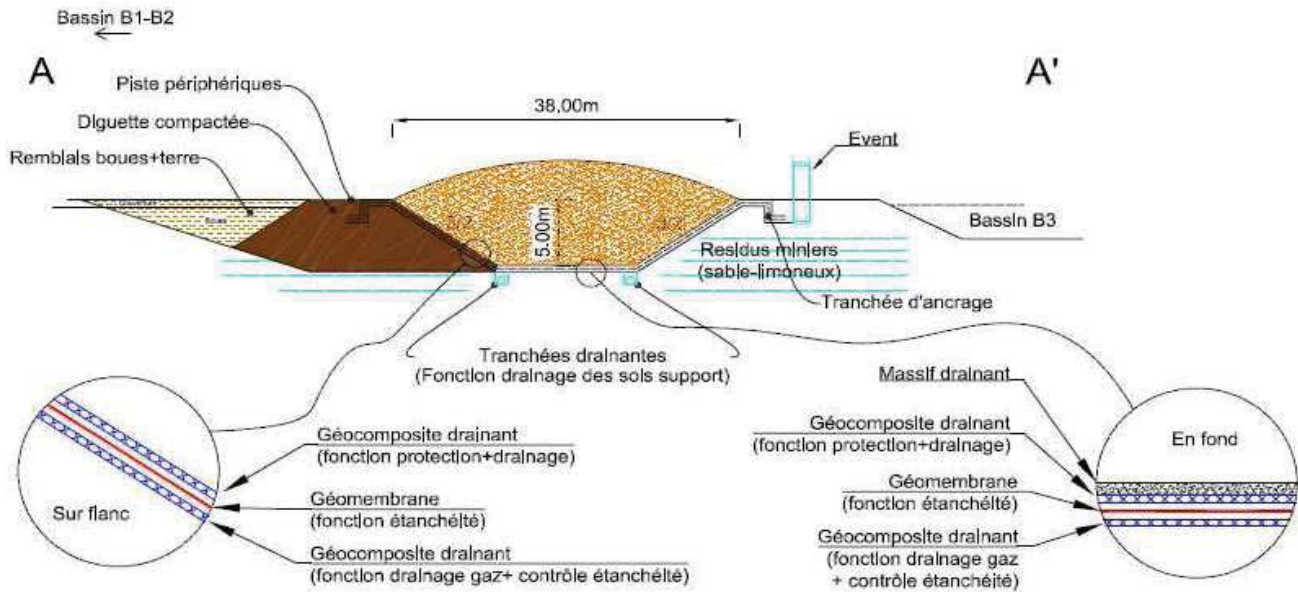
Coupe schématique du dispositif d'étanchéité / drainage de l'alvéole
